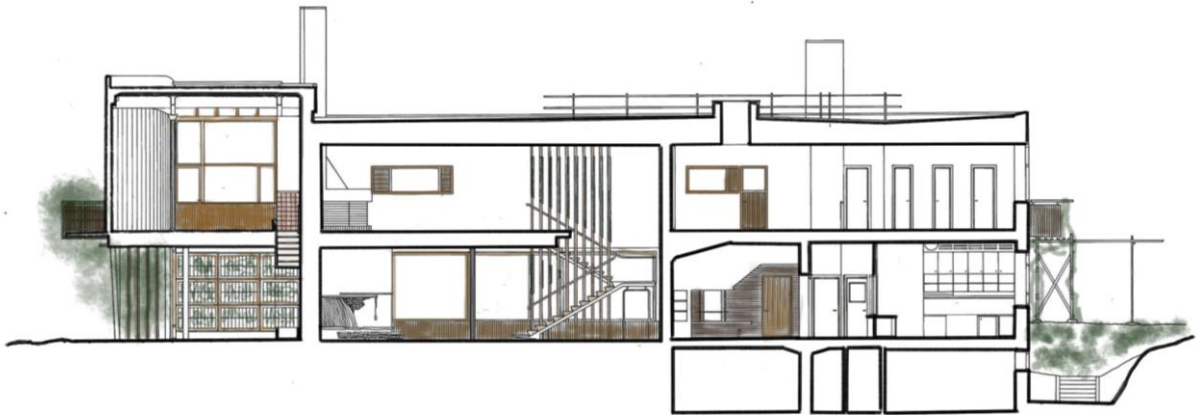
Sección lonxitudinal Vila Mairea. Versión construída_Elaboración propia
